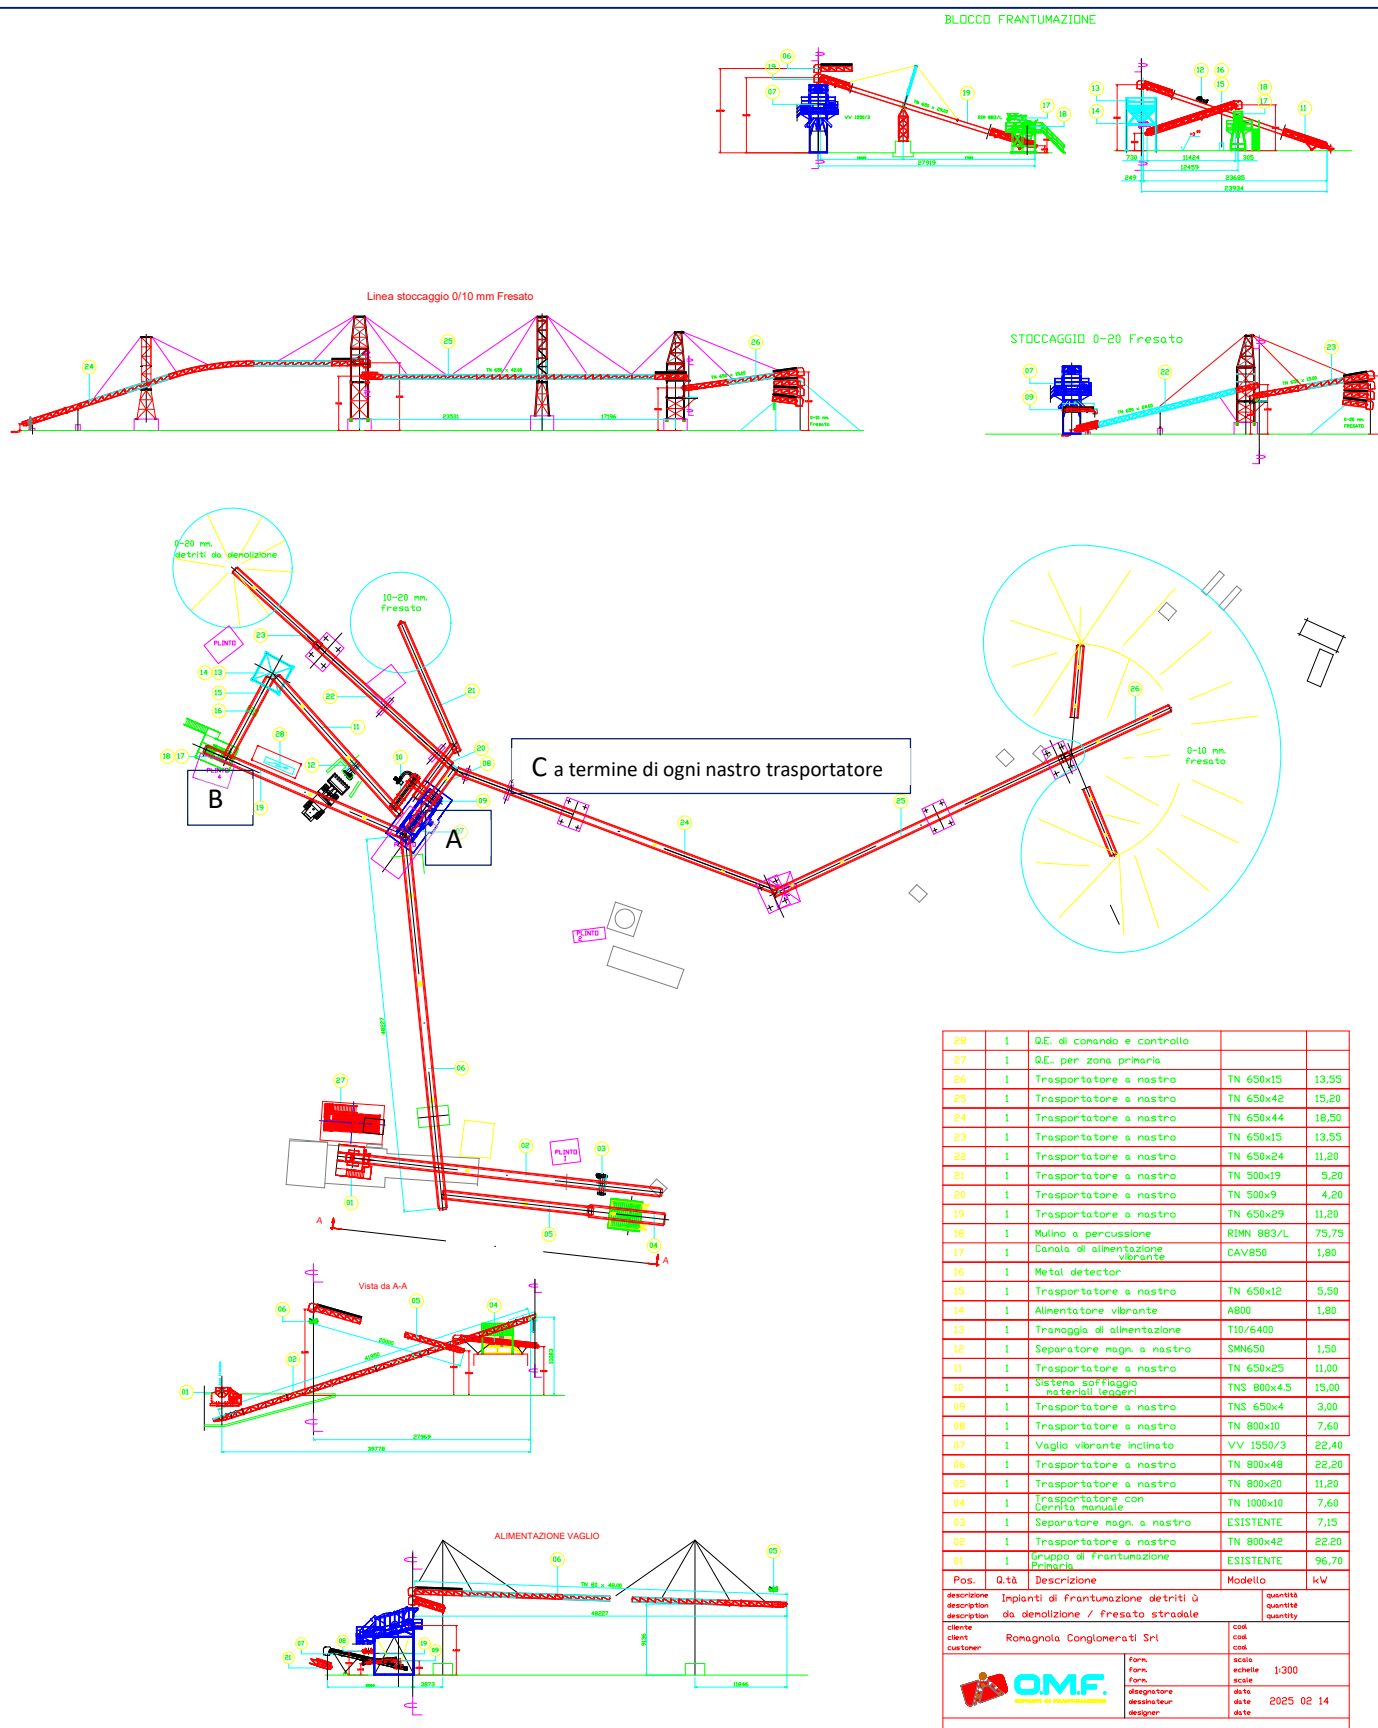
prospetti e planimetria nuovo frantumatore di progetto.
